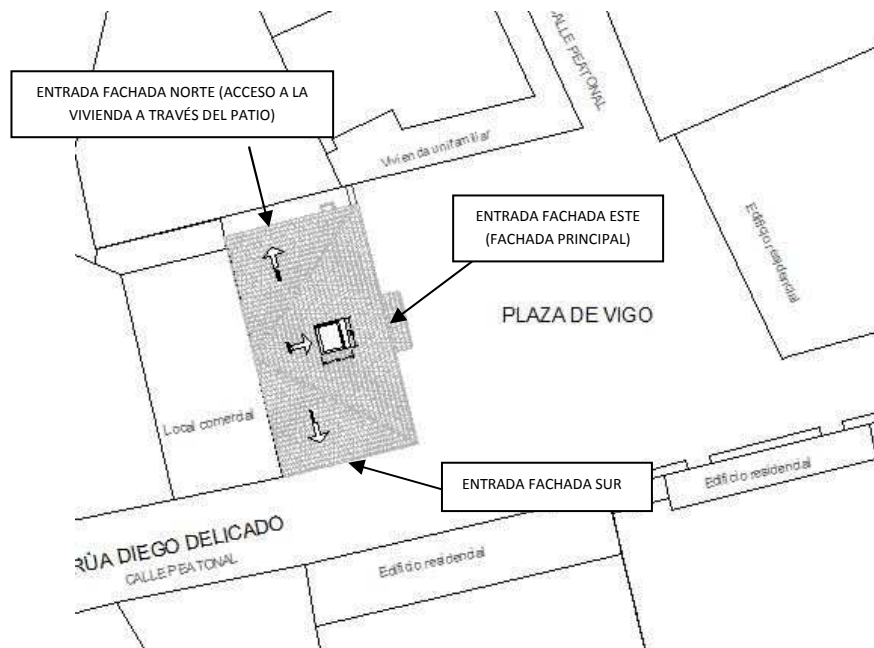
Vista en planta de la vivienda (Fuente: elaboración propia)
